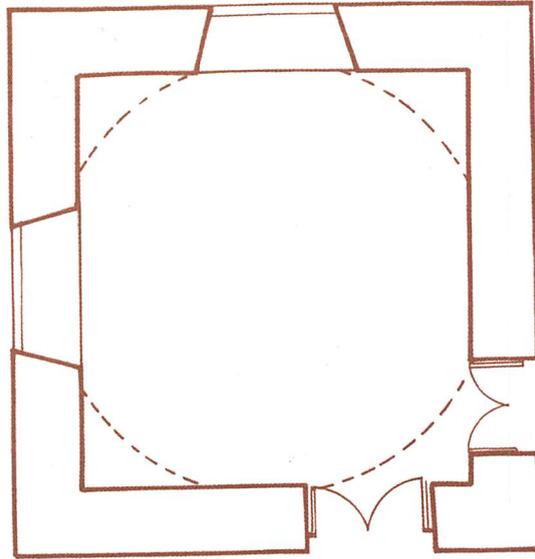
المسقط الأفقى لمسجد التوفيقية
